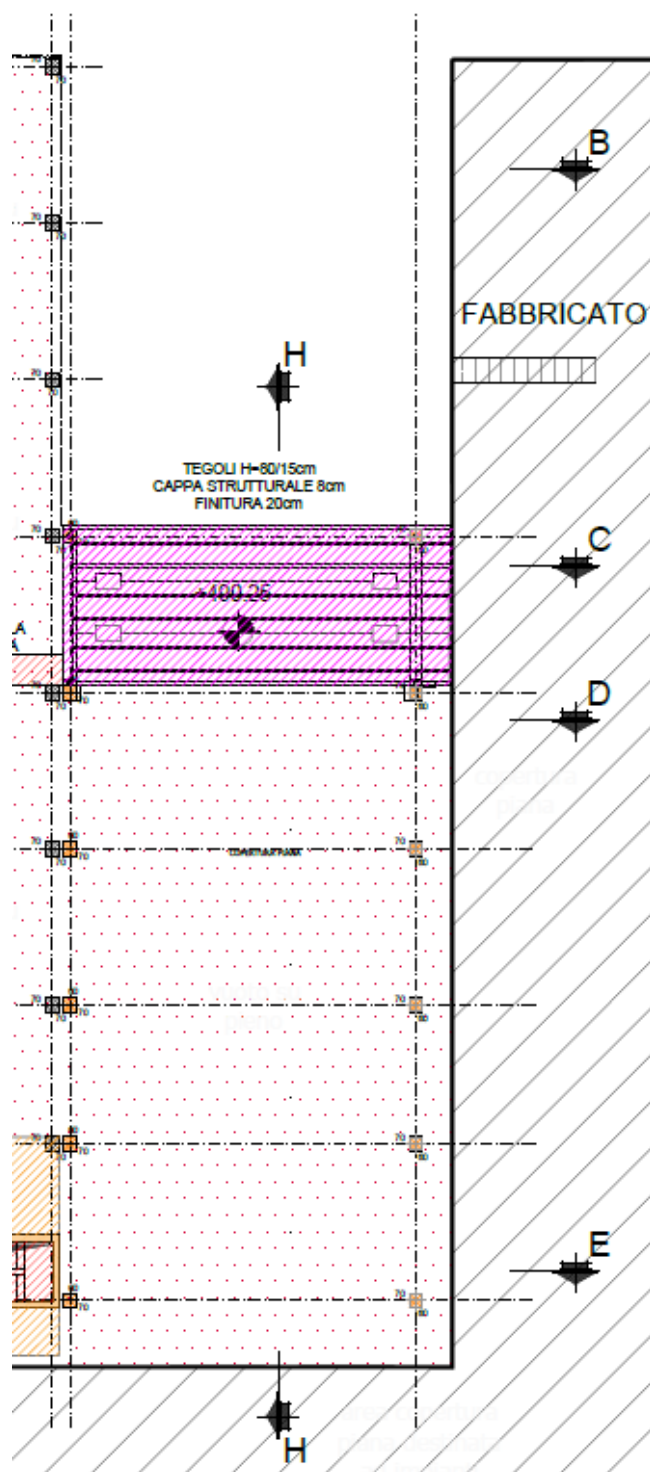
Planimetria piano P1 - Nuovo magazzino spedizioni
